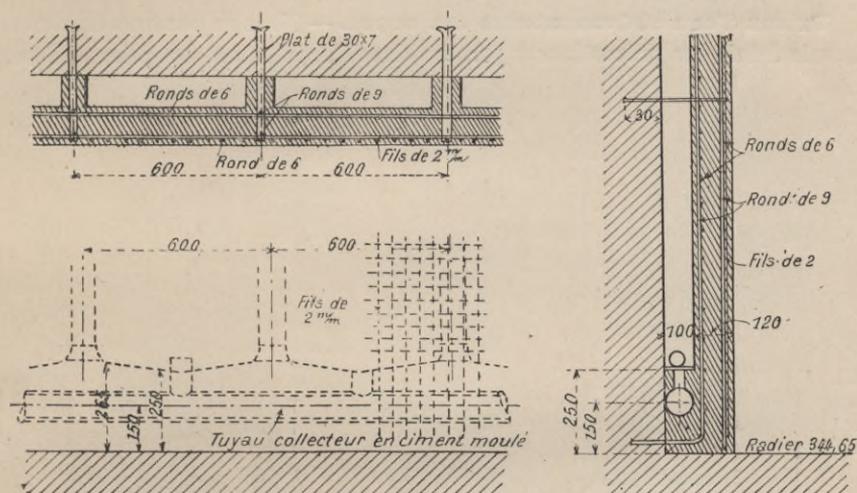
à 55. — Revêtement par cloison en béton armé du barrage de la Mouche.
